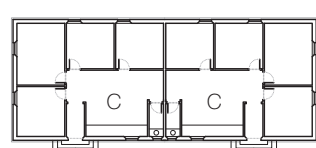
(fuente: AHFB) 2 viviendas en planta baja. Escala 1:500
